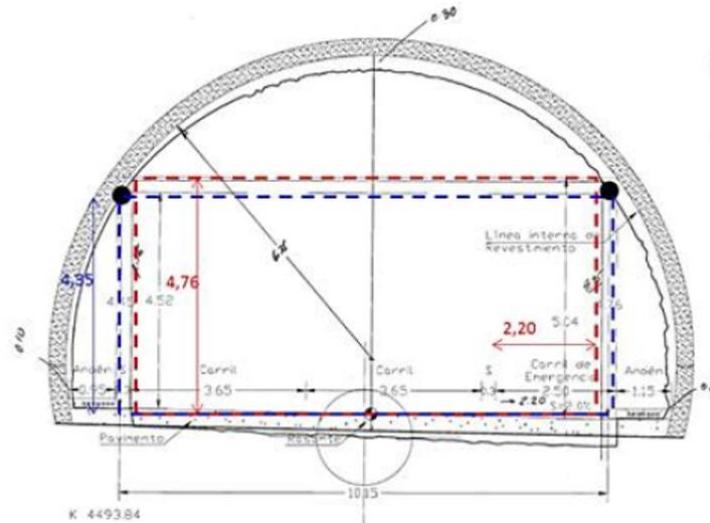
Sección transversal crítica – Falla La Soledad K4+494.
